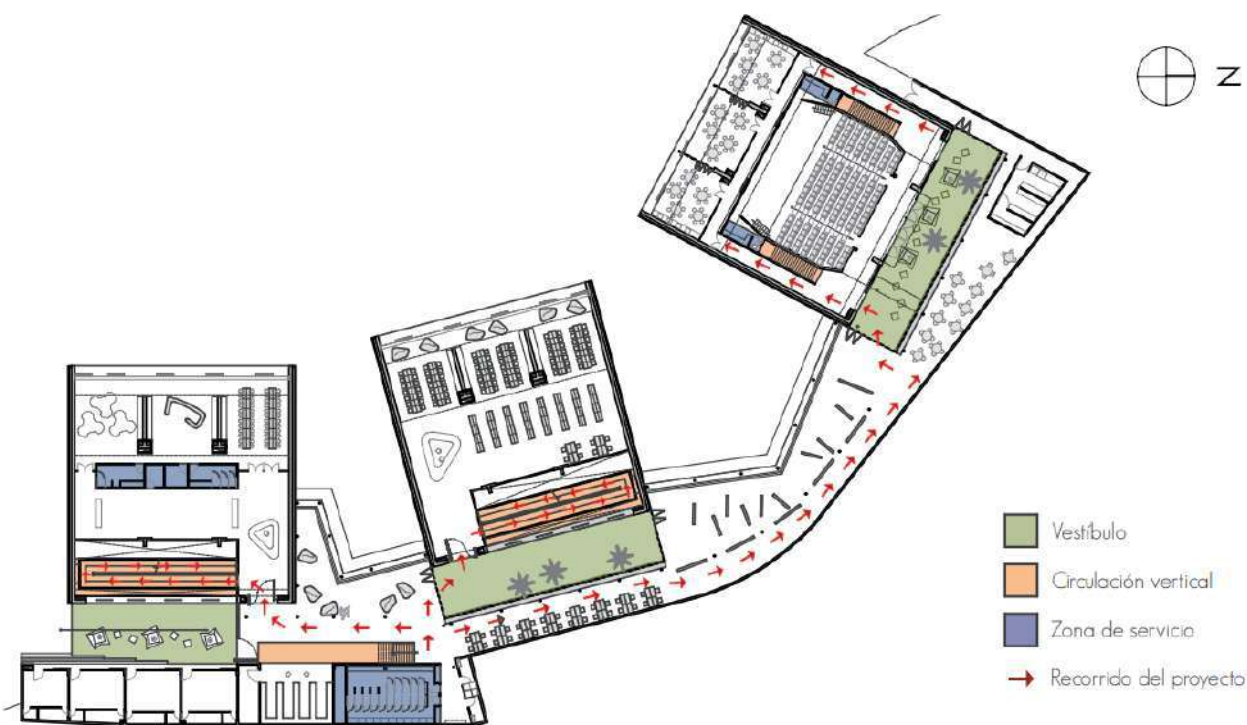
Esquema de circulación Planta baja Parque Biblioteca León de Greiff
